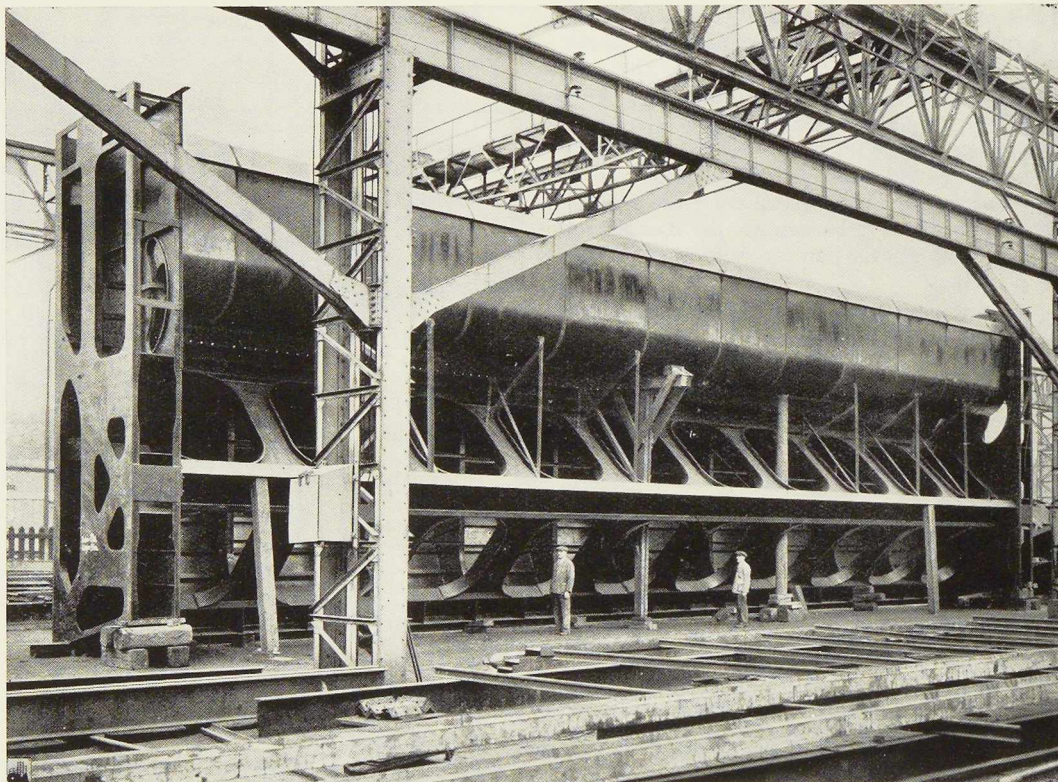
Vue aval de la bouchure principale, montée à blanc à l'atelier. On distingue nettement la charpente de la vanne principale constituée par deux poutres Vierendeel de hauteur constante et inclinées de 45° sur le plan horizontal.
